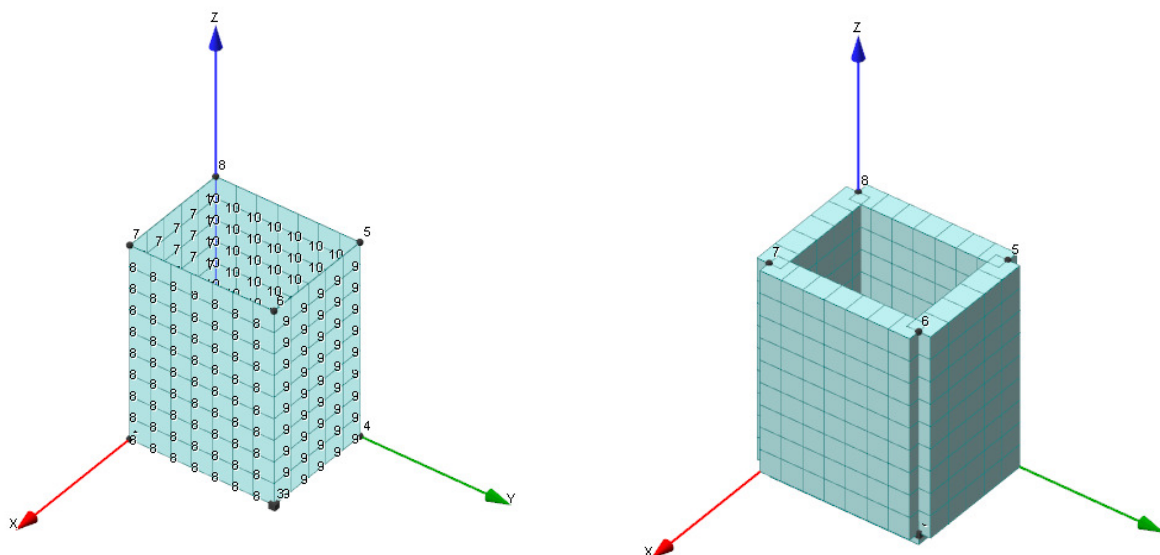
SCHEMA STATICO MODELLO DI CALCOLO E VISTA TRIDIMENSIONALE
